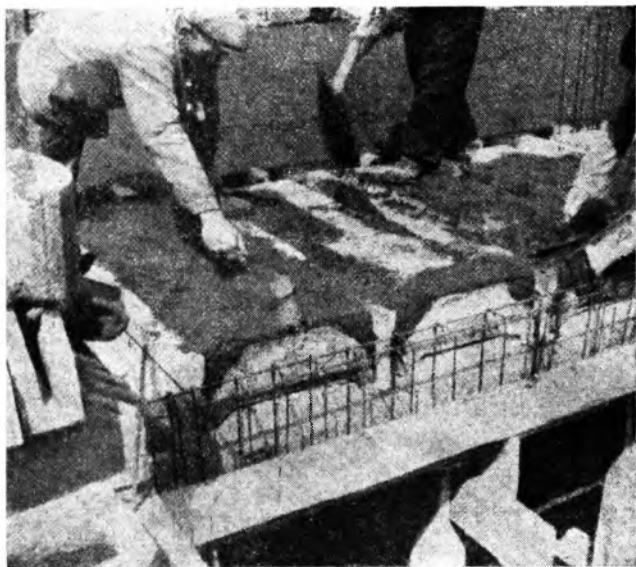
Wypełnianie betonem pachwin zmontowanego stropu. Na pierwszym planie widać ułożone już zbrojenie pod rządnych podciągów.
